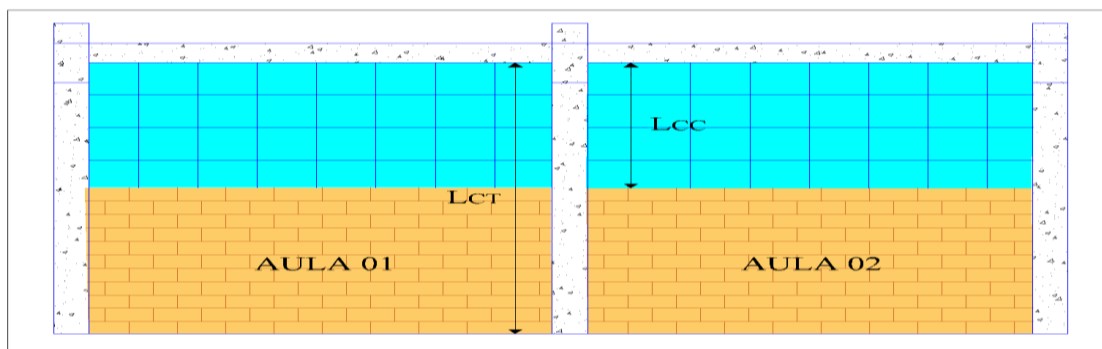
Esquema de una columna típica (Fuente: Elaboración propia)
